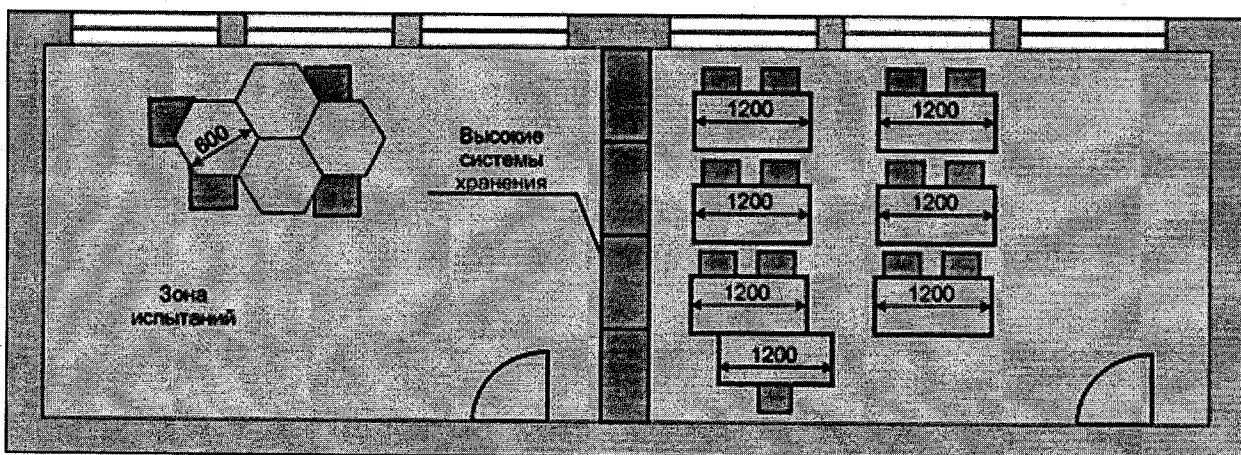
План размещения оборудования в помещении «Наноквантум»
